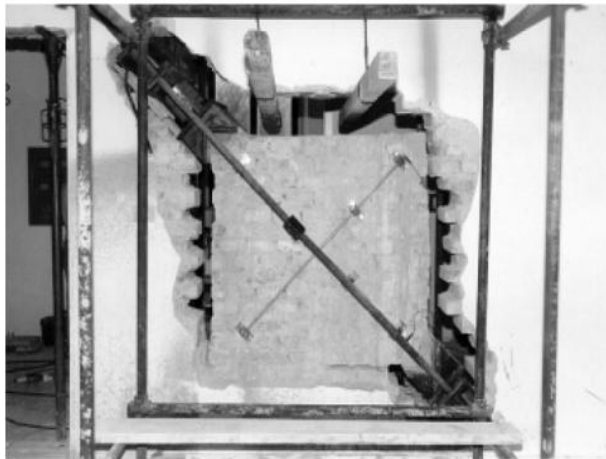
Essai in-situ de compression diagonale sur un muret en pierre naturelle
